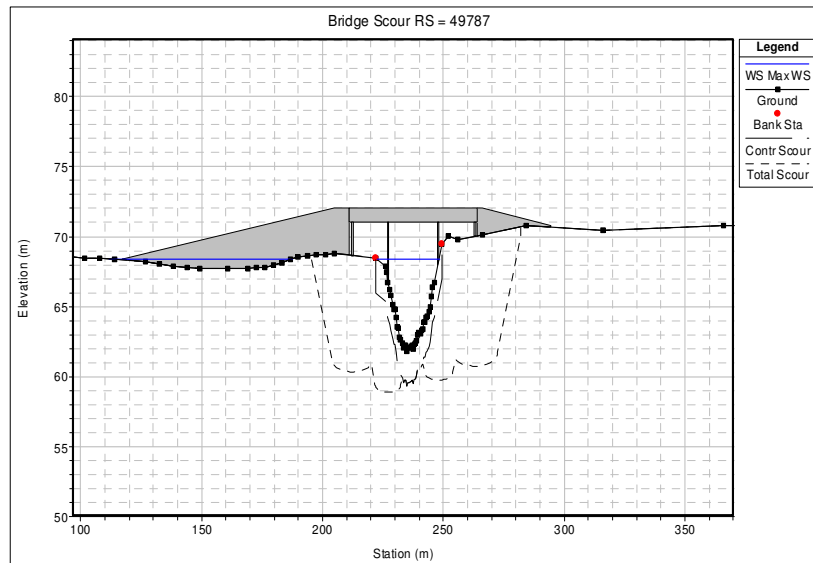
Puente en Piedra Grande - Perfil Transversal erosionado – d50: 0.50mm
